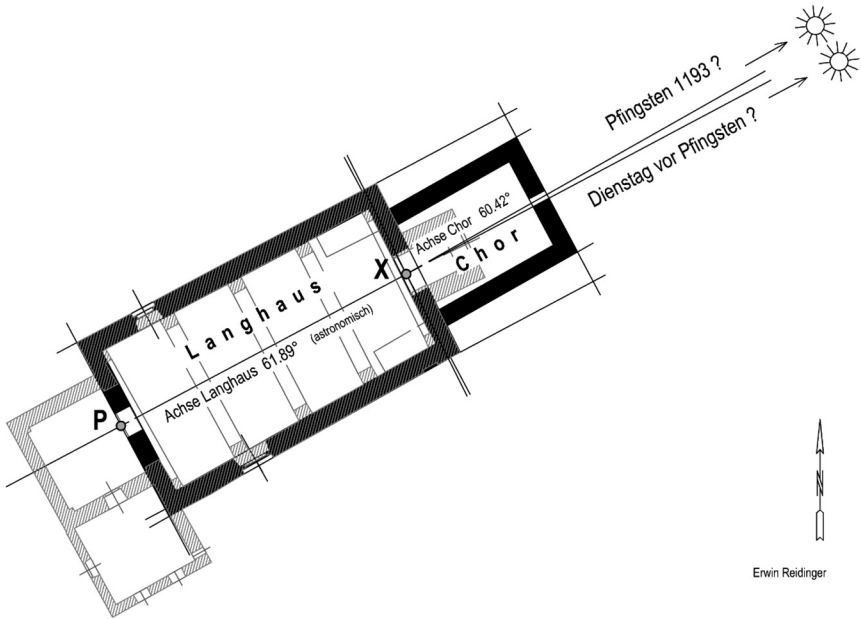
Pfarrkirche Fischau: Rekonstruktion des Gründungsbaus mit Orientierungstagen⁶⁶
